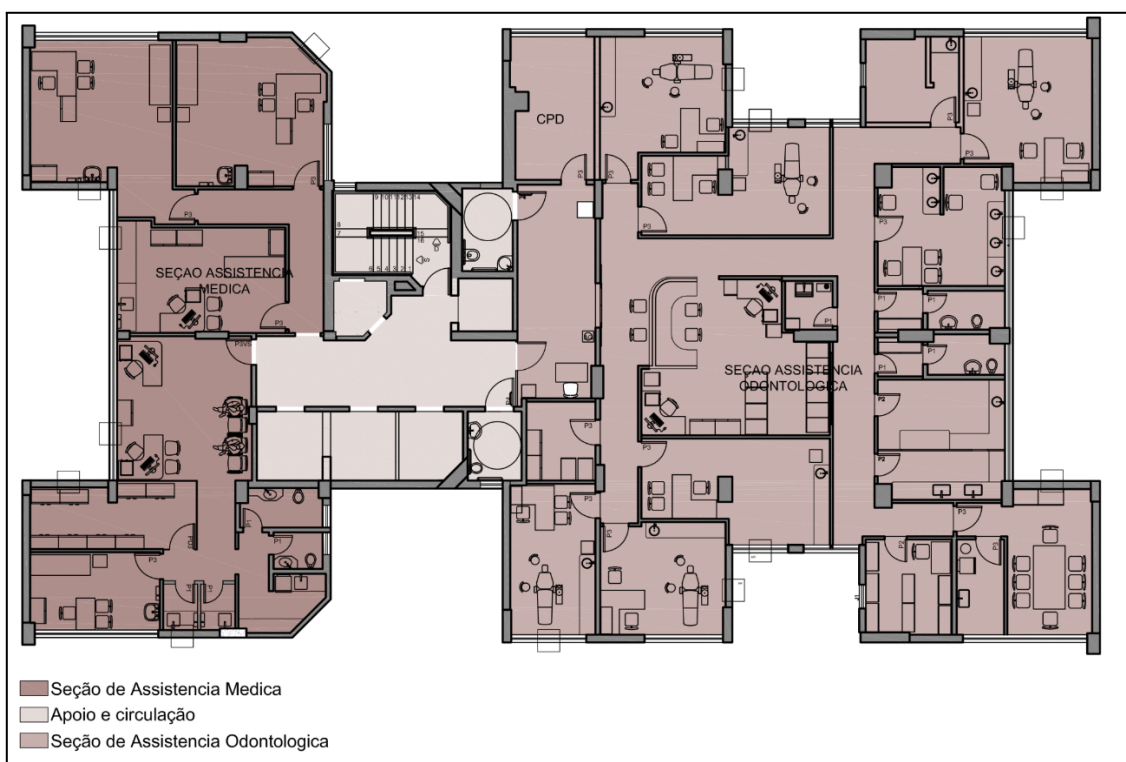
Planta atual do 4º pavimento do prédio da Rua Goitacazes 1475.
